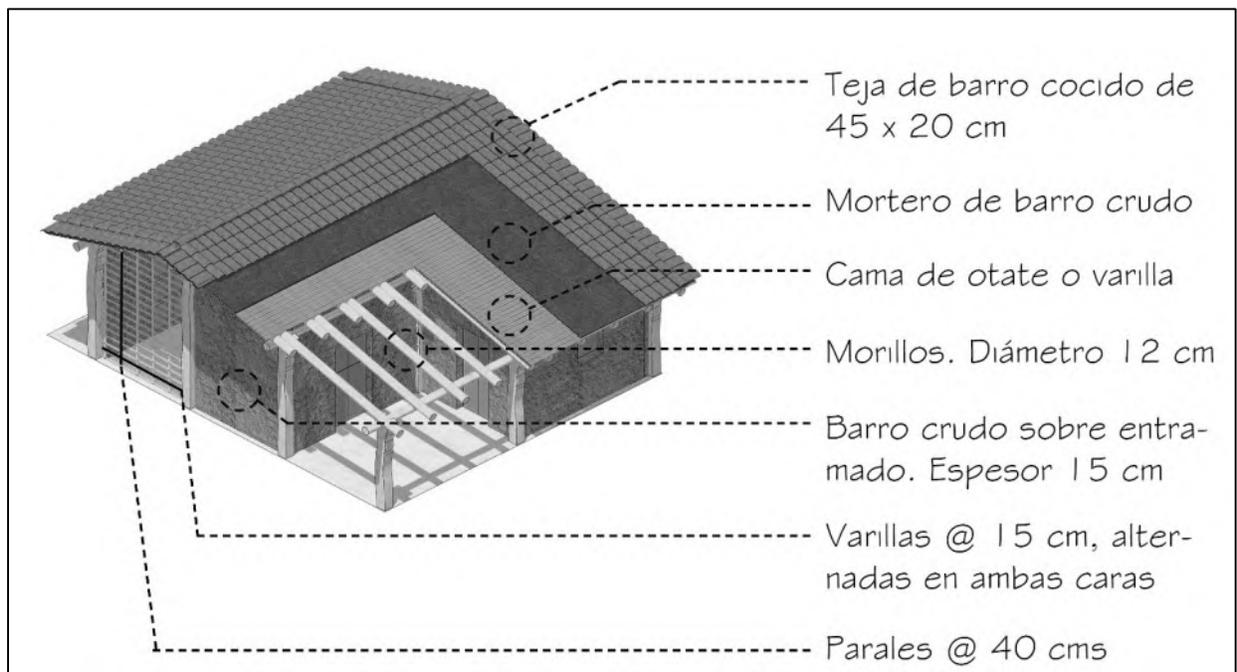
Procedimiento constructivo de la envolvente de la casa de barro. Fuente: elaboración propia.
